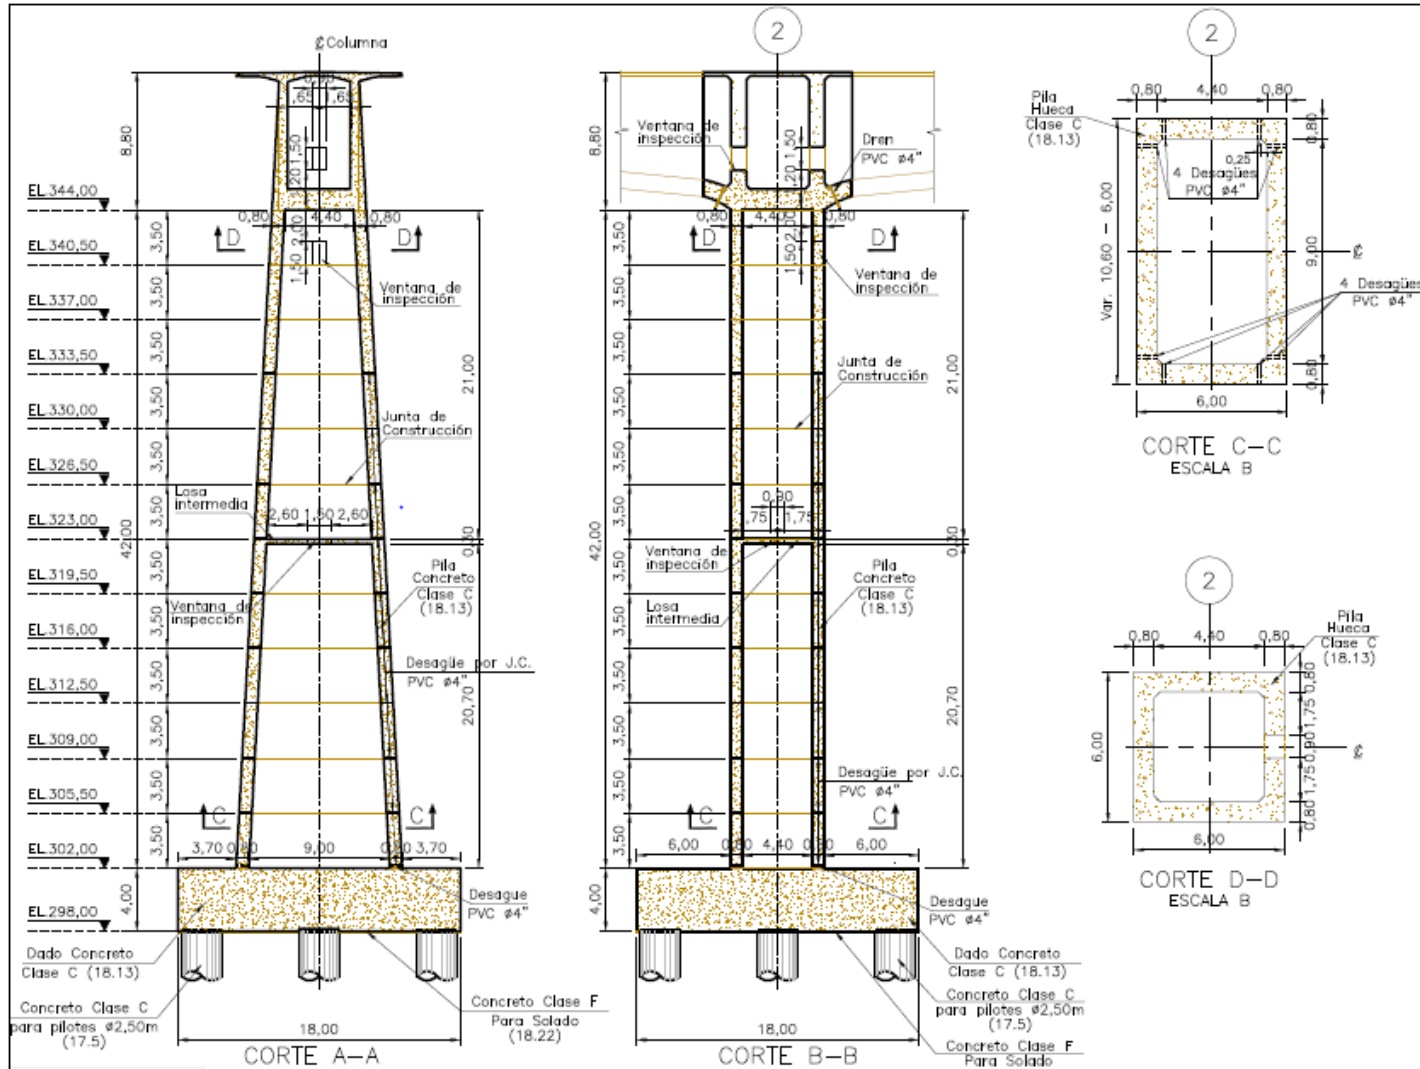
Puente Gómez Ortiz Columna eje 3 y 4 Dimensiones Cortes. ISAGEN
